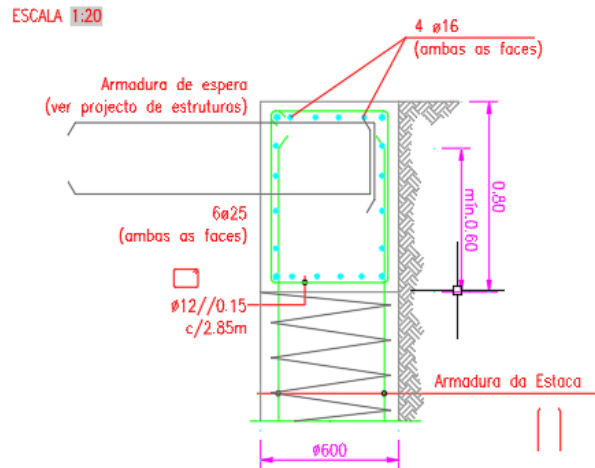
(retirada de [10]): Corte tipo com atenção à pormenorização da viga de coroamento VC1
